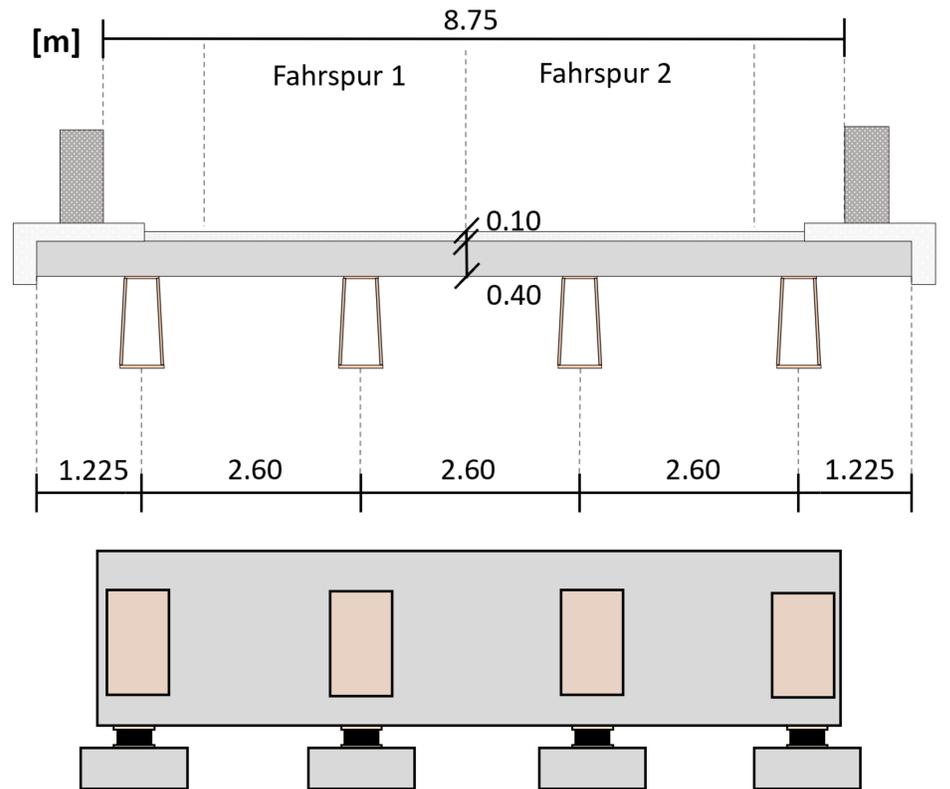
Brückenquerschnitt mit angeordneter Auflast und Fahrbahnführung (oben); Ausführung der Betonquerträger im Mittellaufger (unten)
